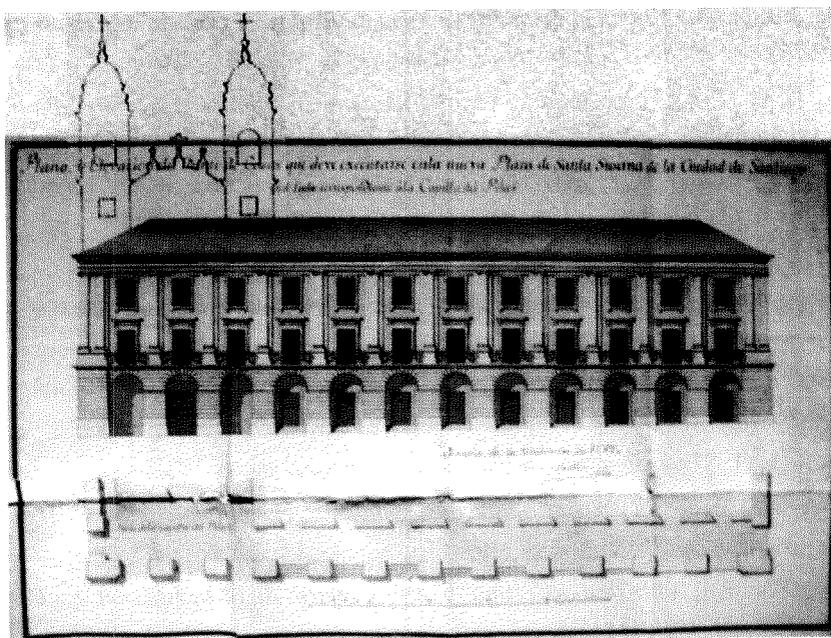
Proyecto de viviendas para la nueva plaza de Santa Susana. 1782. Pedro Martín Cermeño. Al fondo se aprecia la silueta de la fachada de la iglesia del Pilar oculta por las casas (Dibujo sobre el original de J. Morenas Aydillo).
